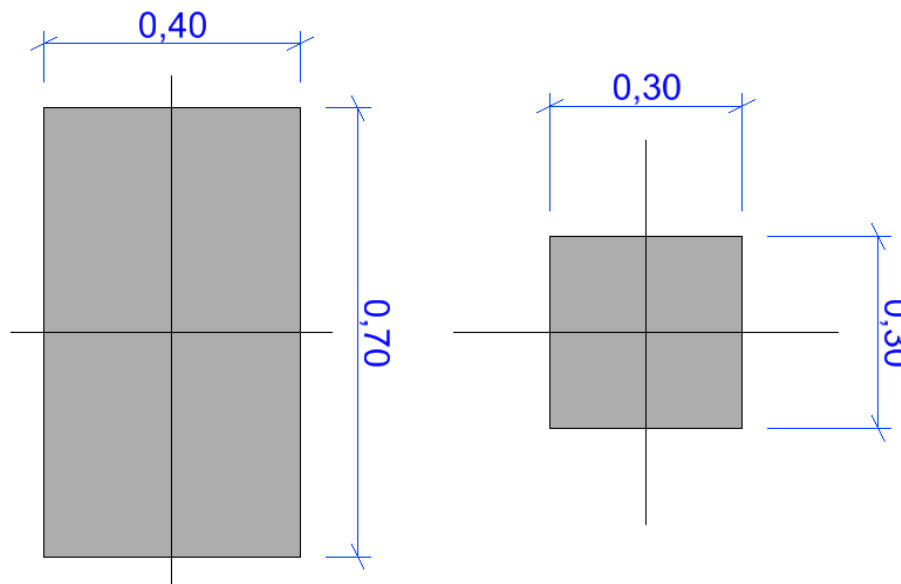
Seccions dels pilars utilitzats. (Font pròpia)
